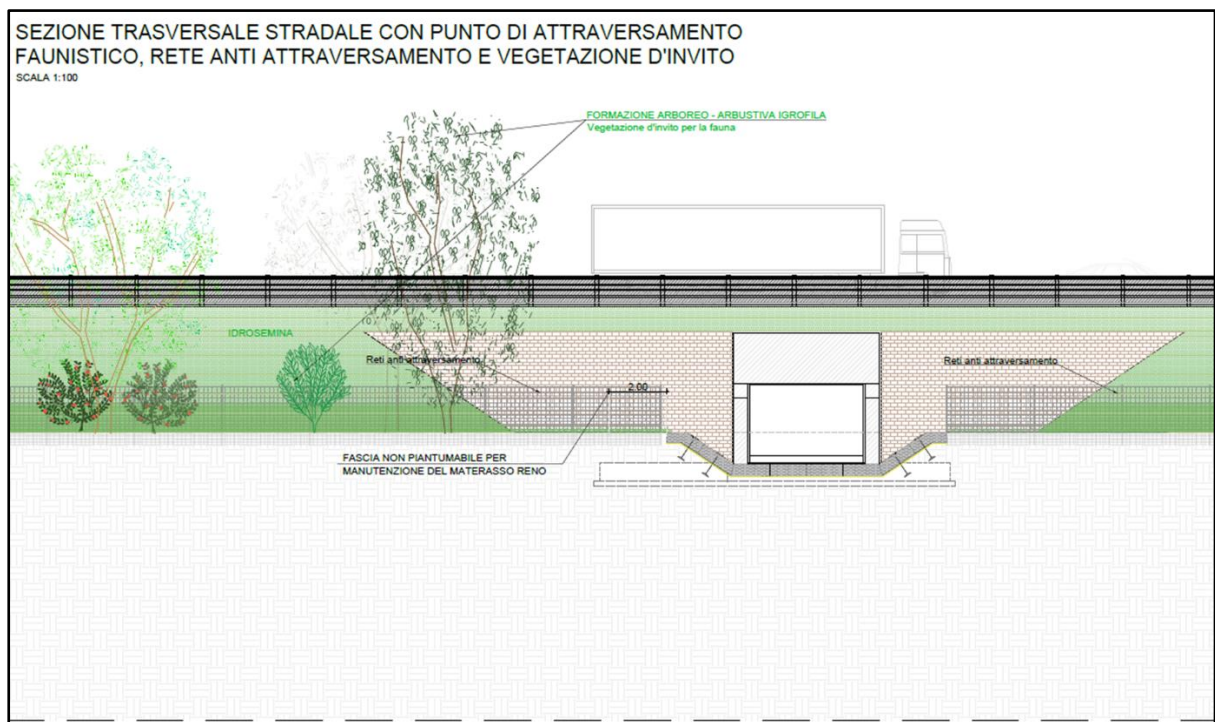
Sezione trasversale attraversamento faunistico, stralcio del "Quaderno delle opere a verde" (cod. T00IA01AMBRI08B)
